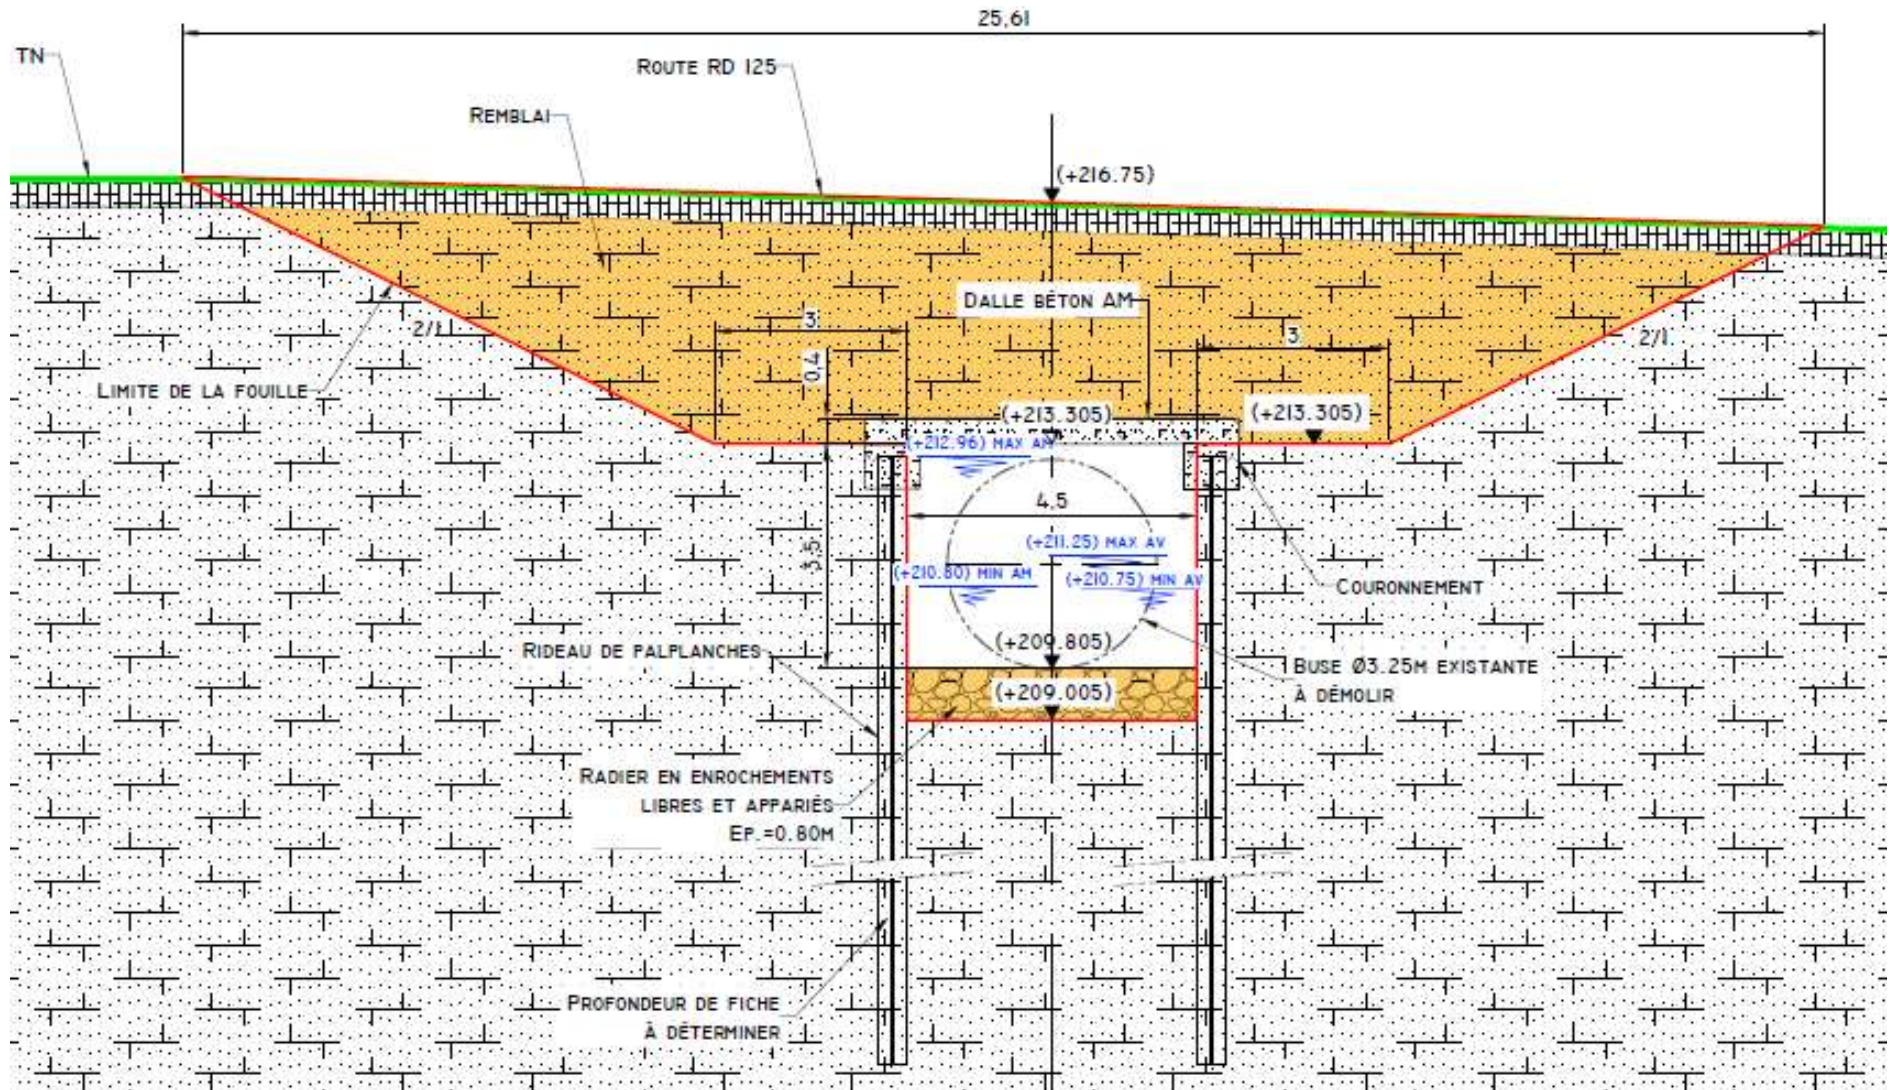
Plans décrivant les travaux – Etat final post travaux – Profil en travers.
